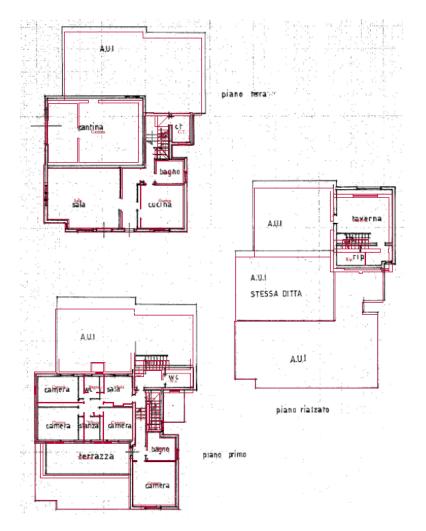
Sovrapposizione planimetria catastale con stato di fatto villino (fuori scala) – Allegato N.3
